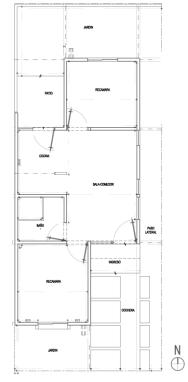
Planta arquitectónica de vivienda aislada del caso base. Fuente: NAMA.
